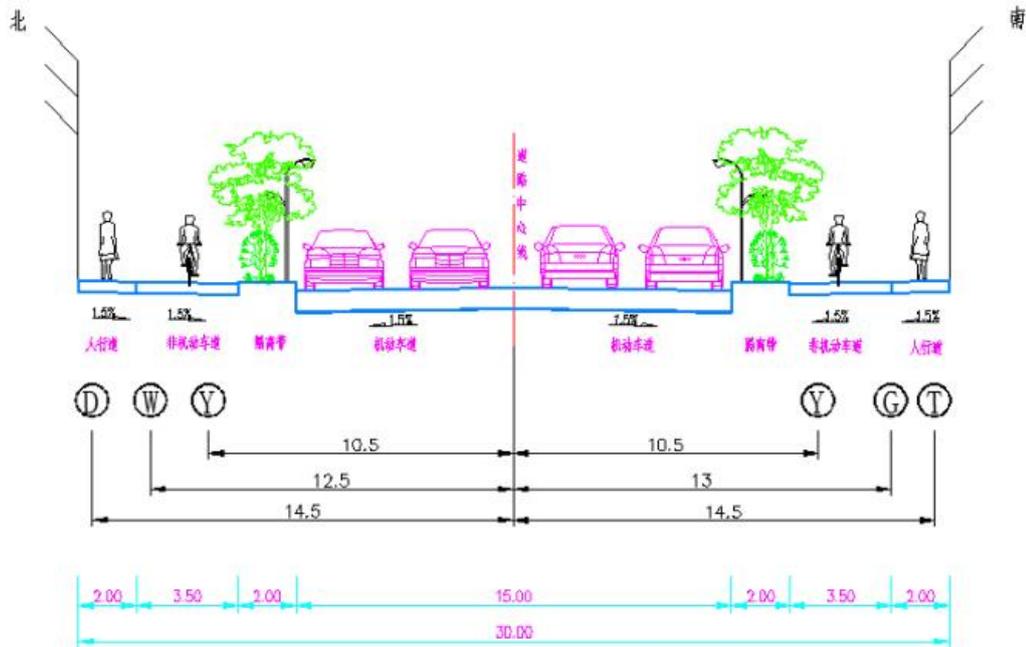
富强街（海滨大路-东风大路）道路横断面图
